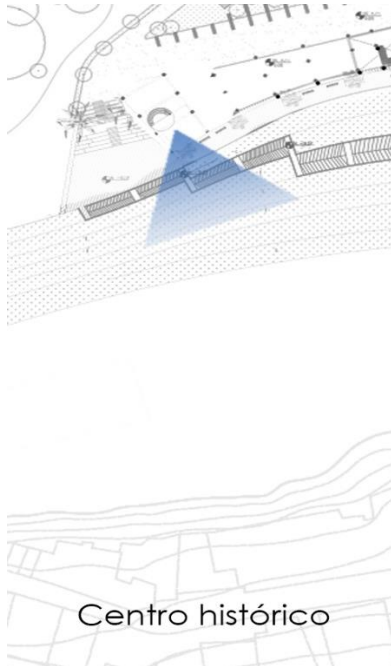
Planta del mirador y la vista hacia el paisaje. Elaboración propia (2016)
